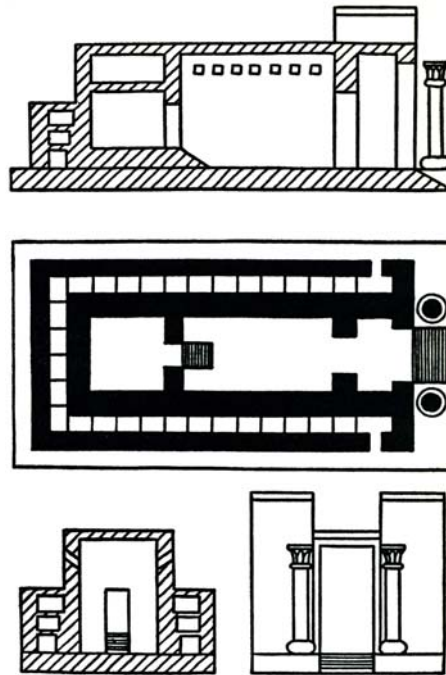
Planta y alzado del templo de Salomón (Fuente: D. Harden).
